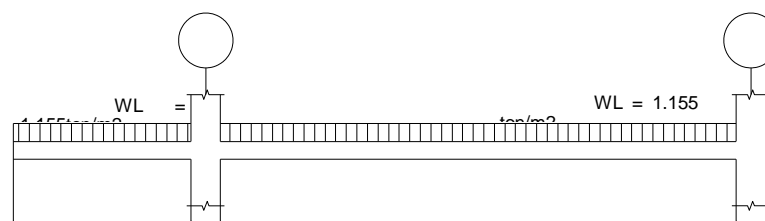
CARGAS ACTUANTES EN LAS VIGAS
